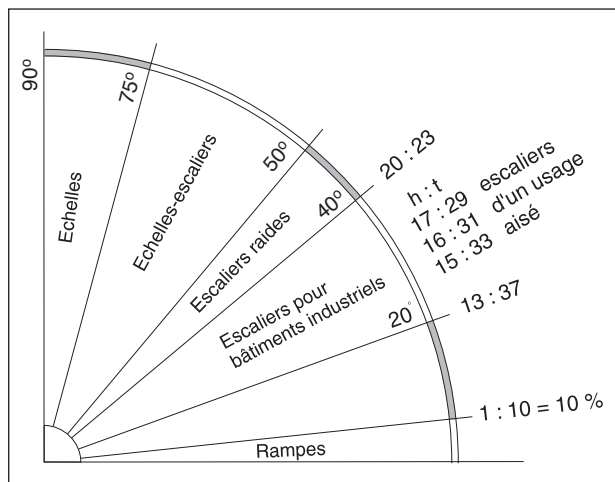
Pentés pour rampes, escaliers et échelles
